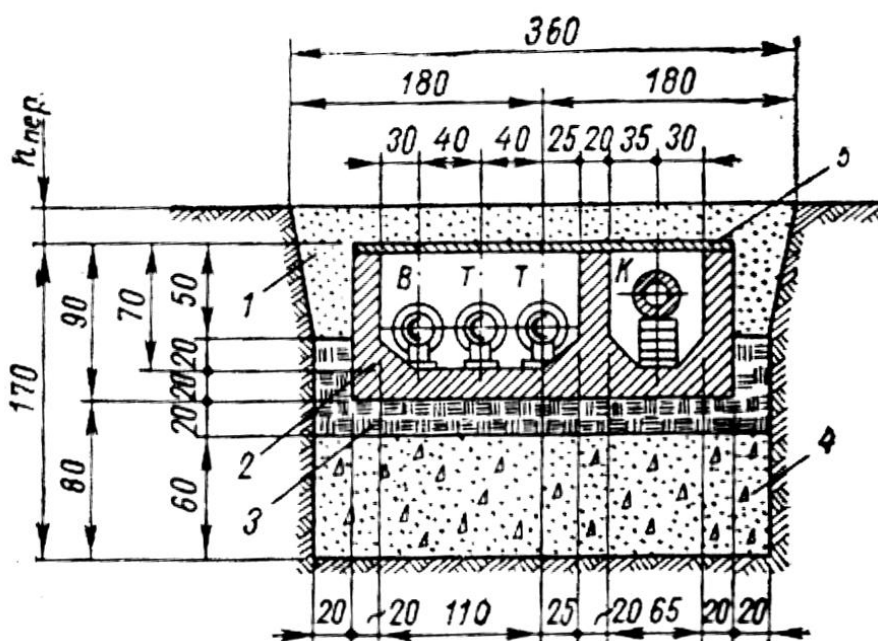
Непроходной двухсекционный железобетонный канал:
